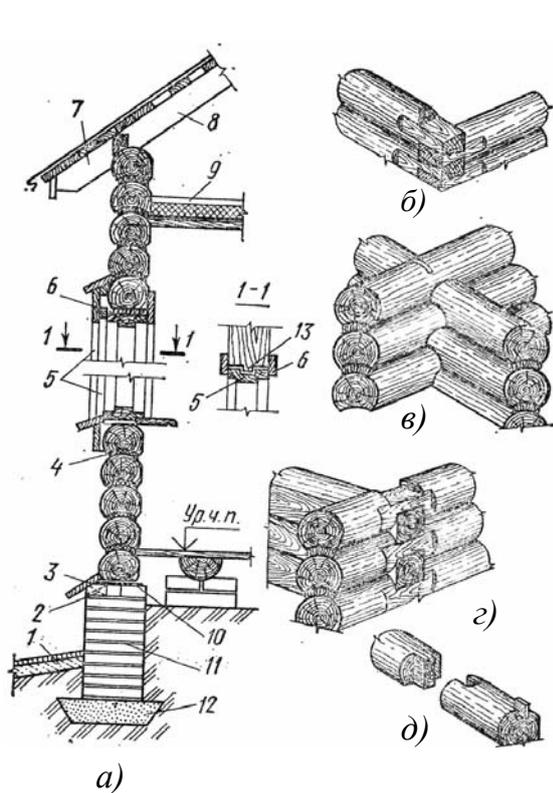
Конструкция бревенчатых зданий: а) разрез по стене; б) угловая врубка без остатка; в) то же, с остатком; г) примыкание внутренней стены к наружной, д) наращивание бревен по длине; 1 – отмостка; 2 – антисептированная пробка; 3 – сливная доска; 4 – конопатка мхом или паклей; 5 – оконная коробка; 6 – наличник; 7 – карнизная кобылка; 8 – стропильная нога; 9 – чердачное перекрытие; 10 – изоляция стены (два слоя толя, просмоленная доска); 11 – цоколь; 12 – песчаная подушка; 13 – гребень
